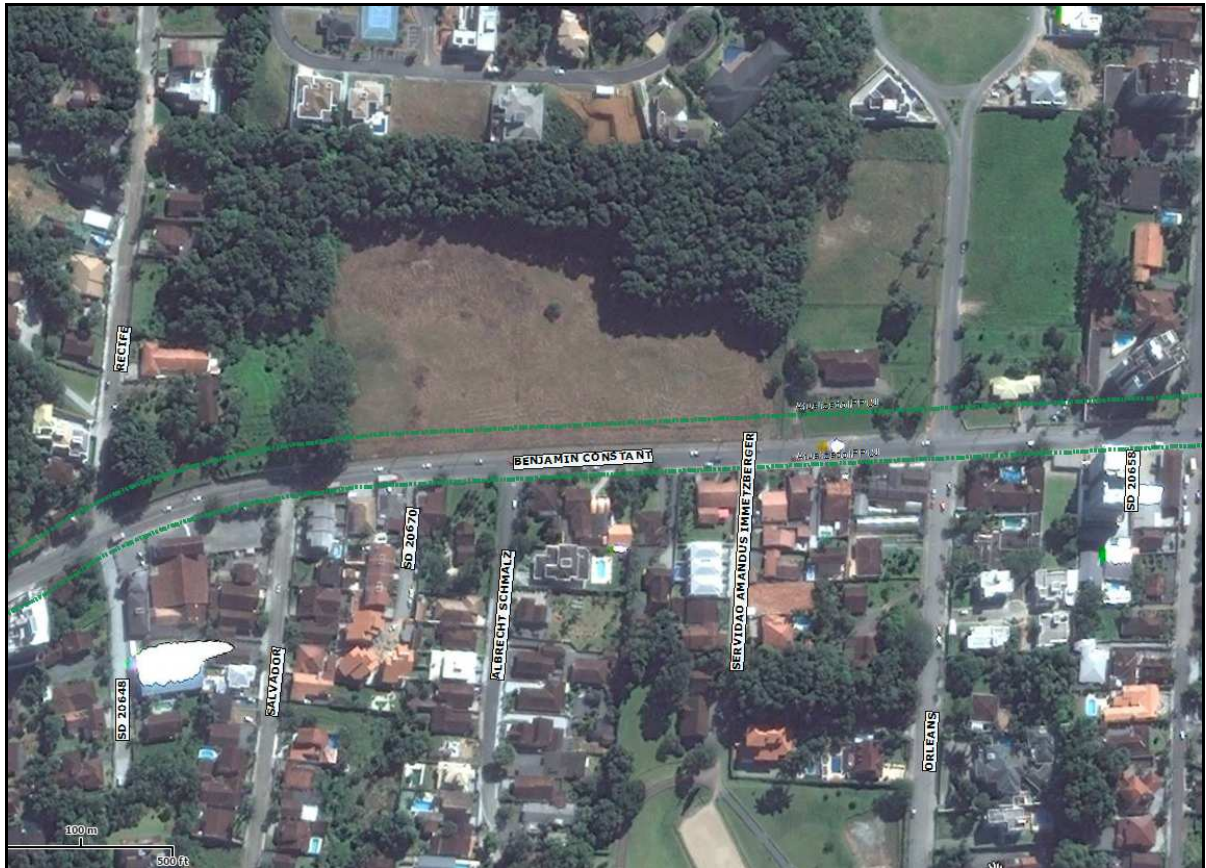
Plano Viário: Alargamento da Rua Benjamin Constant
